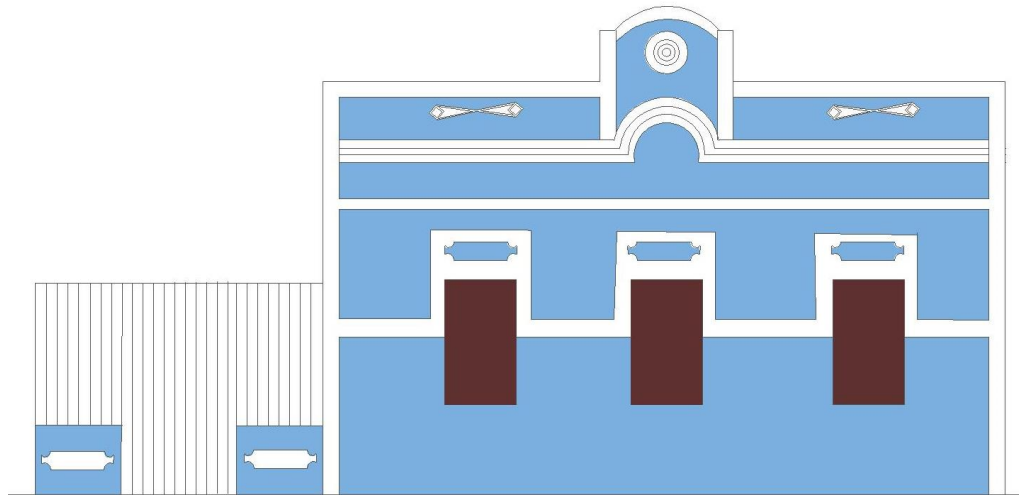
Fachadas 21 e 22 (Vetorização)Fonte: Autora, 2021.
